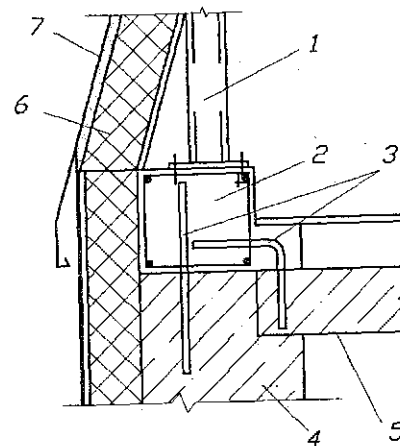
Узел опирания стоек каркаса мансарды на стены здания: 1 — стойка рамы; 2 — железобетонный пояс по периметру стен; 3 — анкера; 4 — кирпичная стена; 5 — плита перекрытия; 6 — утеплитель стен; 7 — оцинкованное железо по обрешетке
